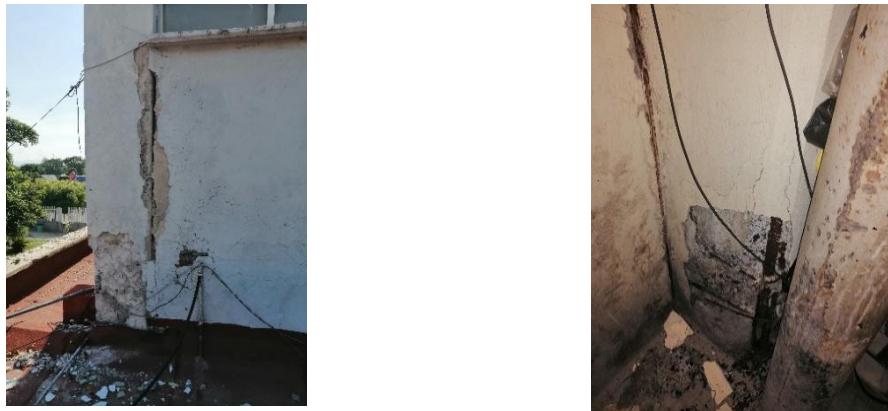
Columna de la esquina superior izquierda de la fachada, vista exterior y vista interior.
